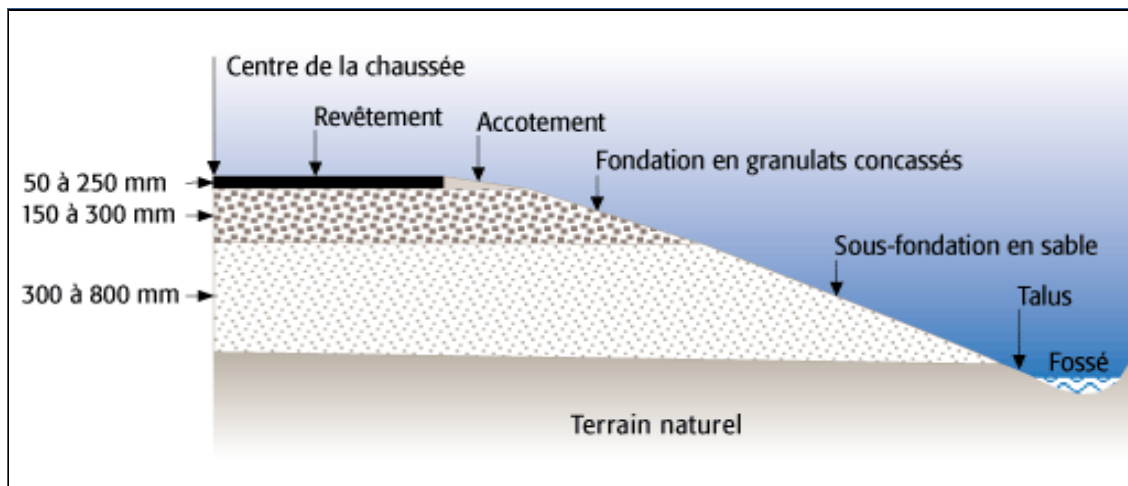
Coupe type d'une chaussée, tiré de MTQ (2007n).
